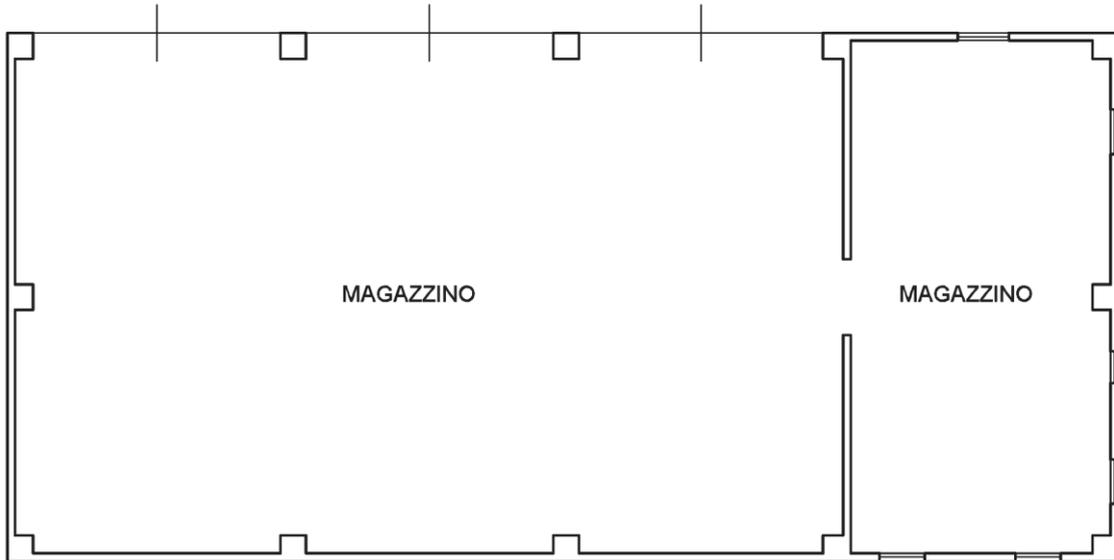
schema a vista (fuori scala) del fabbricato rustico oggetto di esecuzione
